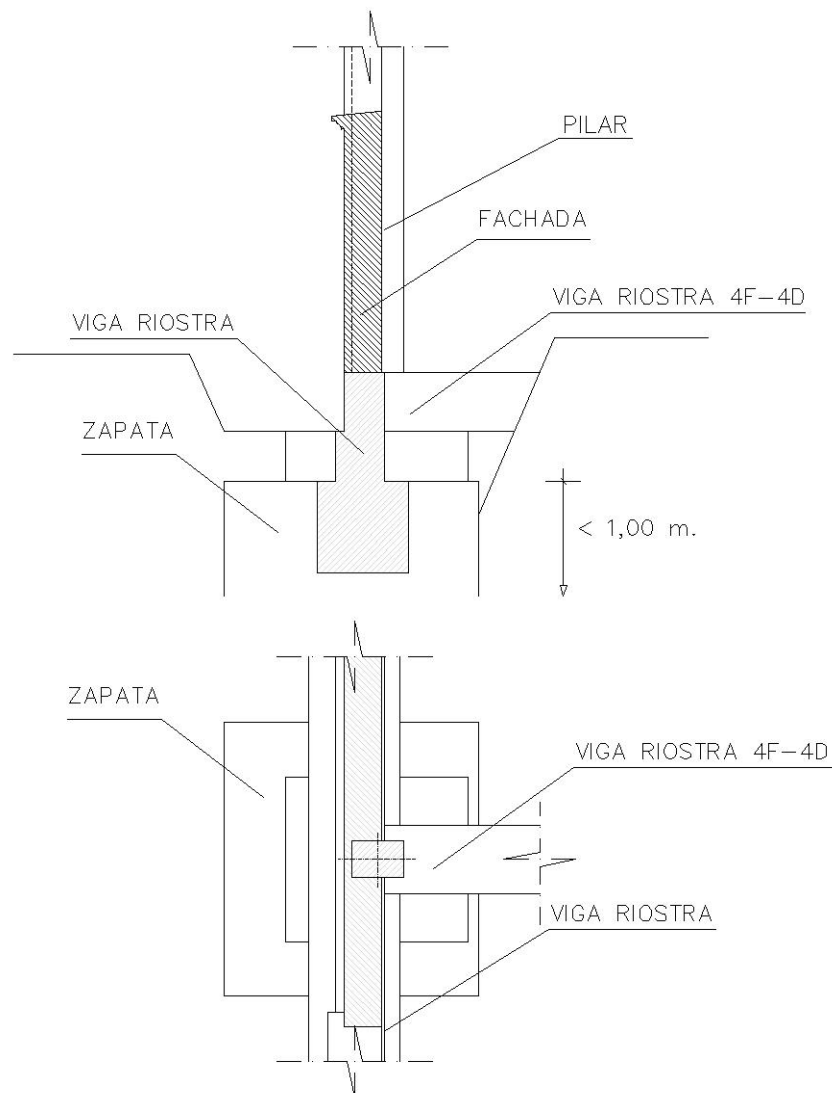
Detalle de la cimentación del pilar 9D.
